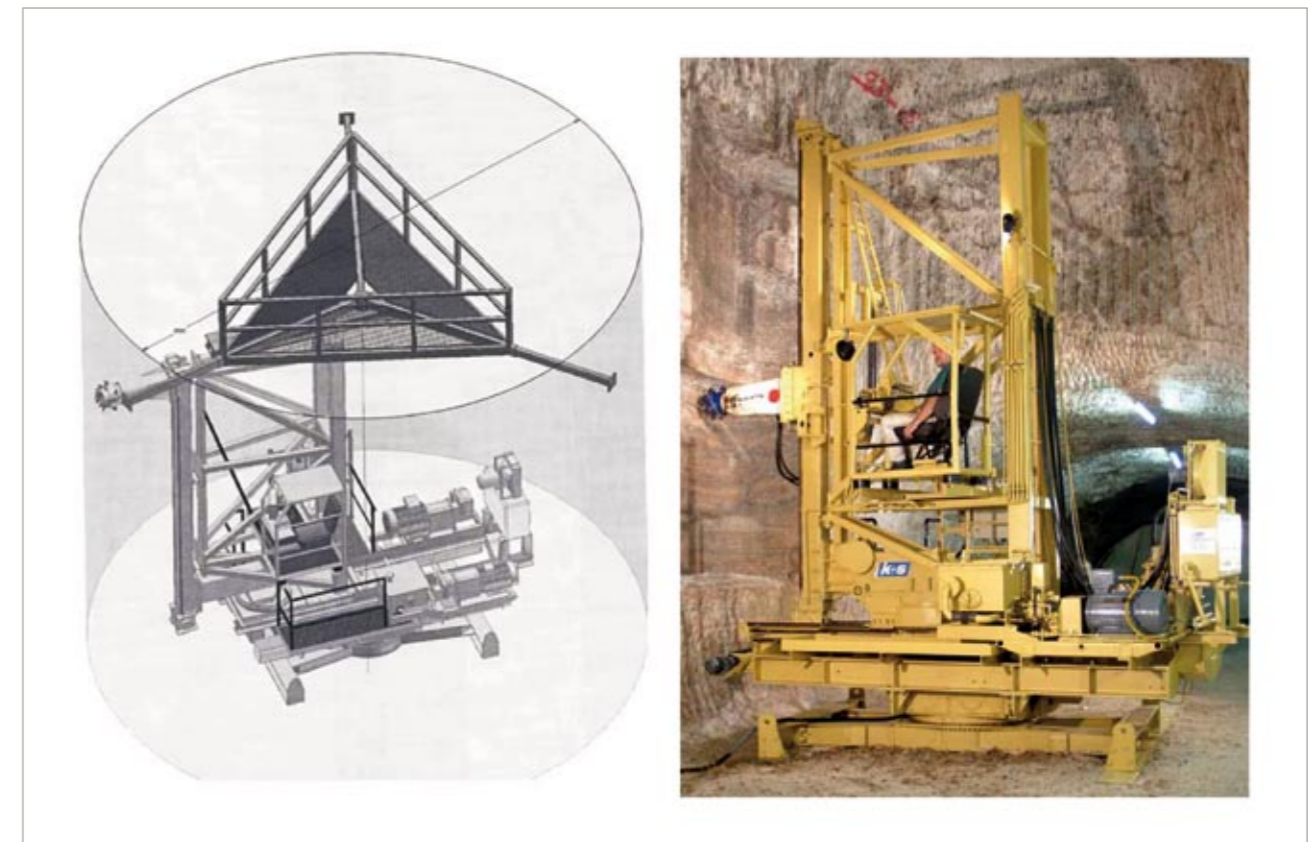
Schachtfräse SF 01 für das Rauben des Ausbaus und das Schneiden des Gebirges / Shaft cutter SF 01 for drawing off the shaft support and cutting the rock
